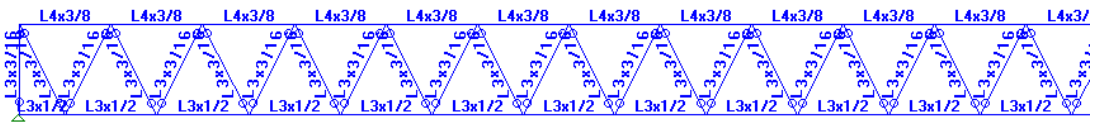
Perfis viga treliçada TIPO D – Tesoura Warren (b)
